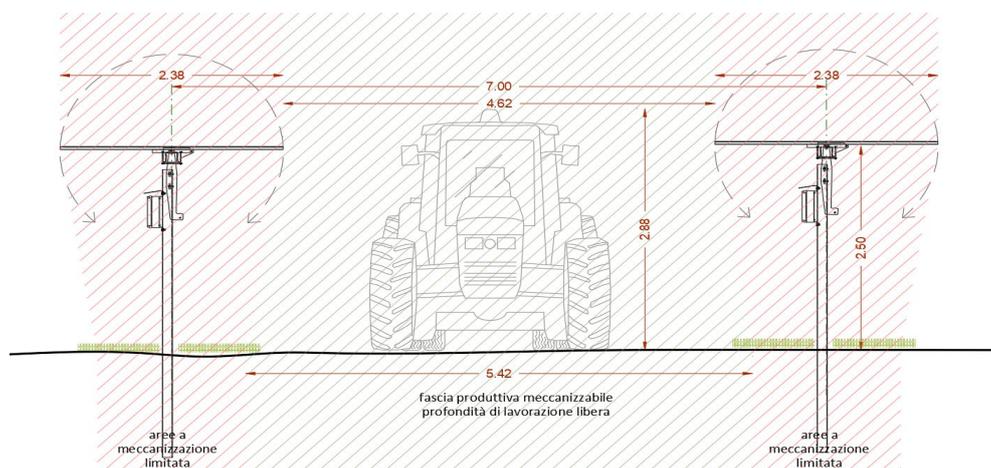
Assetto culturale inerbimento - attività di sfalcio
